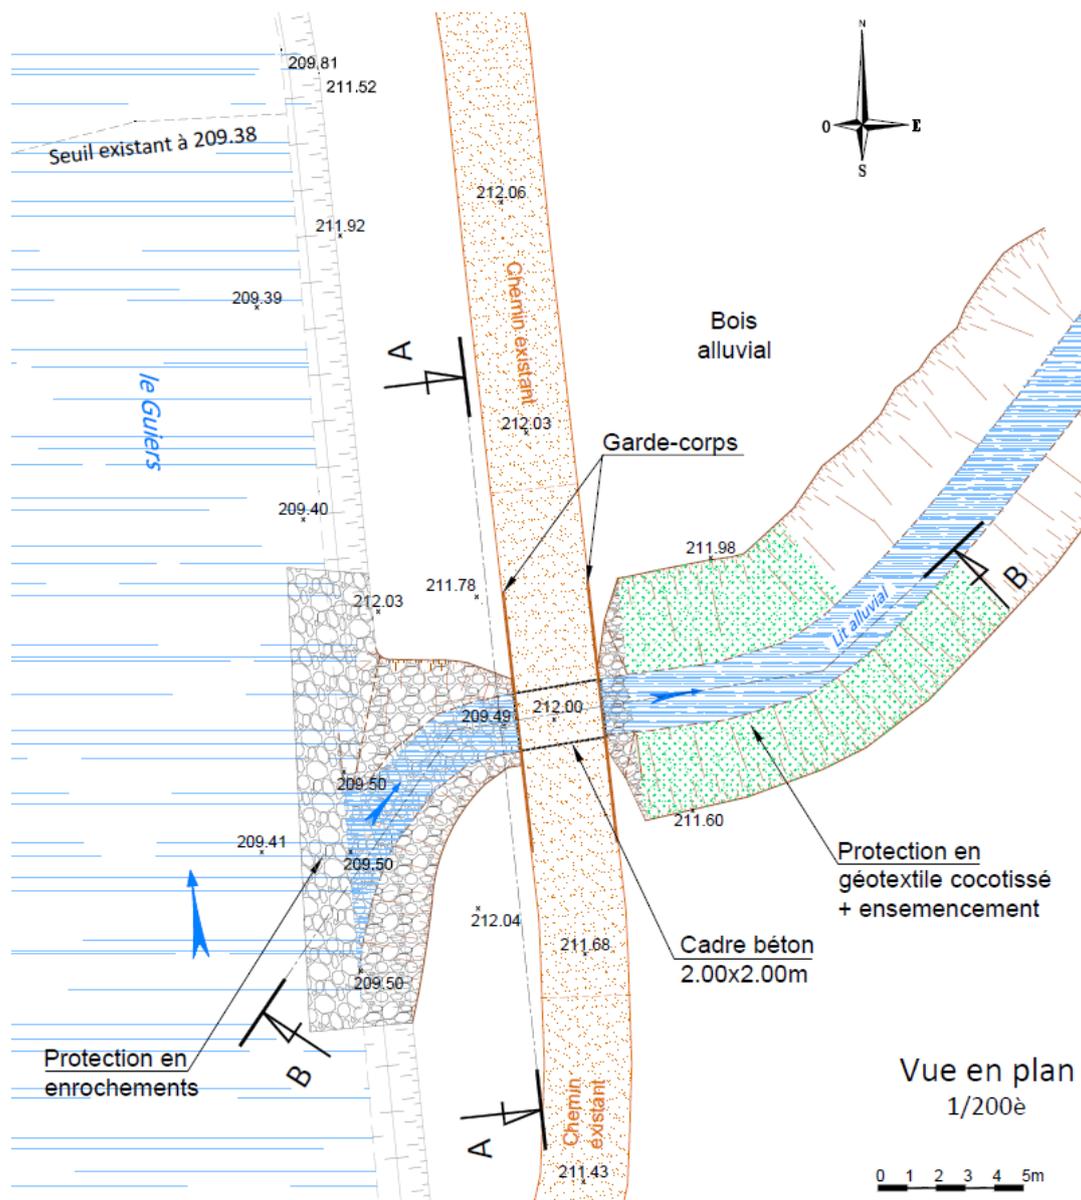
Vue en plan de l'ouvrage d'alimentation du bras secondaire
